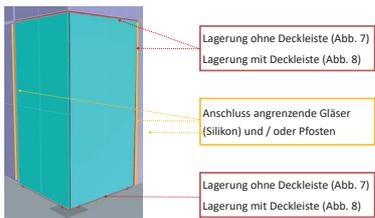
Schema der Ganzglasecke mit Lagerbedingungen.
